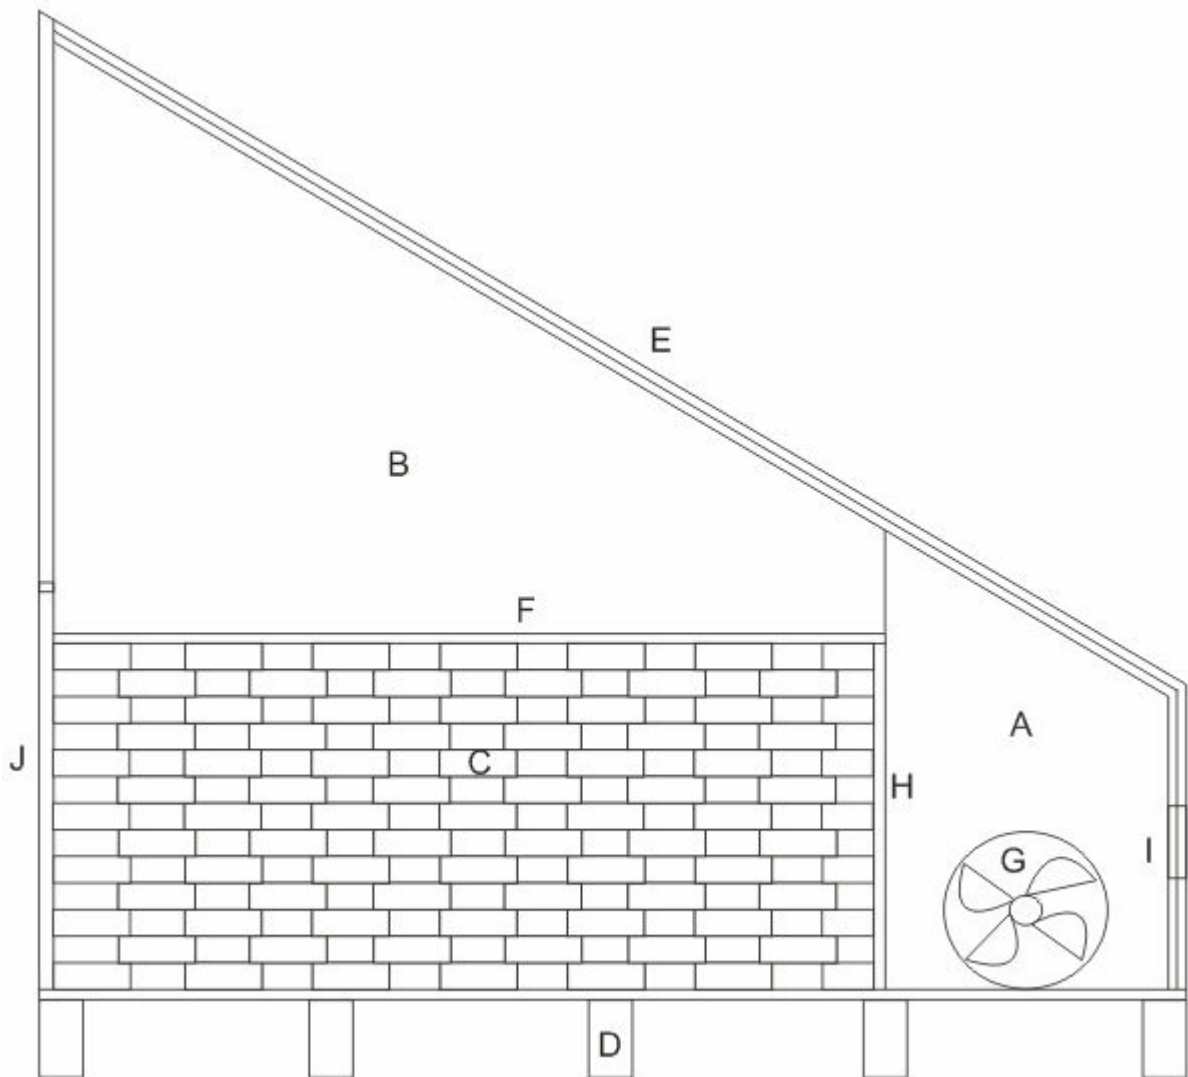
Vista lateral da estufa solar e seus detalhes construtivos (A= suporte para fixação do ventilador; B= divisória de PVC; C= parede vazada de tijolo; D= fundação; E= camada dupla de PVC; F= chapa coletora; G= ventilador; H= chapa compensada; I= janelas para renovação do ar; J= porta de carga e descarga).
